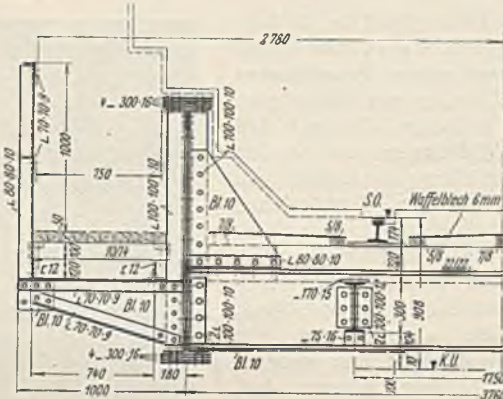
Musterentwurf für beschränkte Bauhöhe. Querschnitt.
